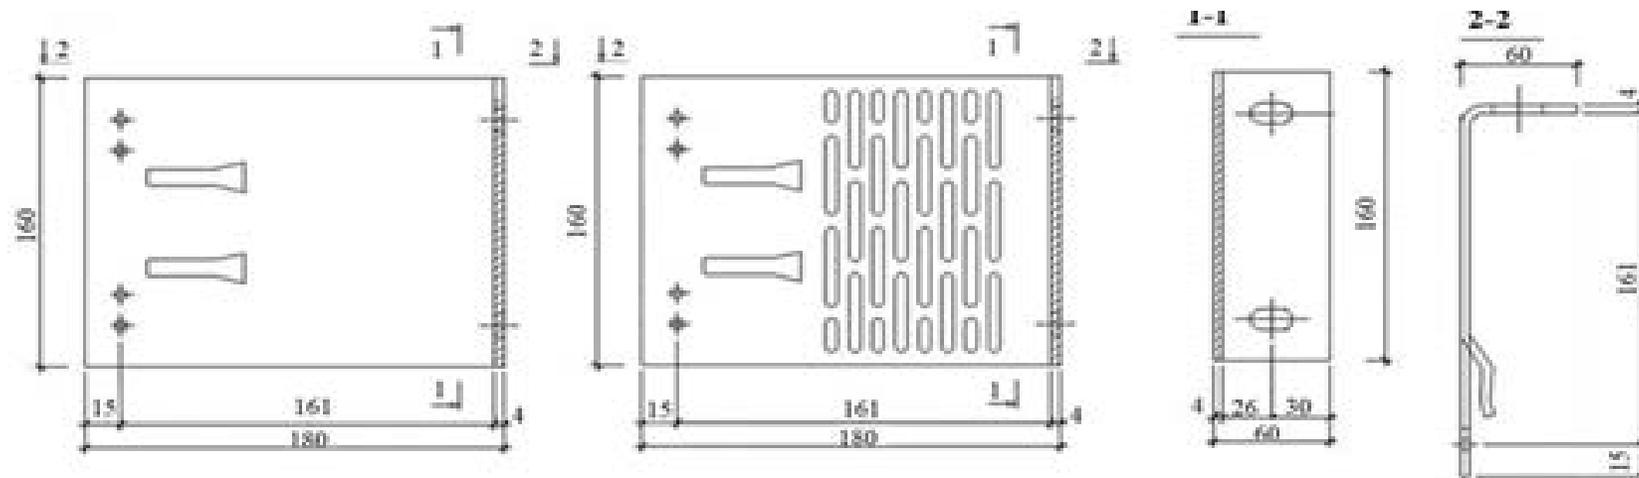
Конструкції кронштейнів для монтажу вентильованих фасадів
